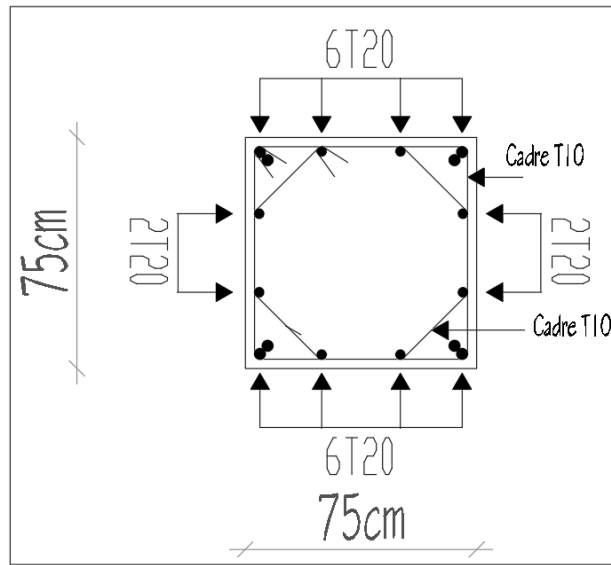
le schéma de ferraillage des poteaux 75*75
